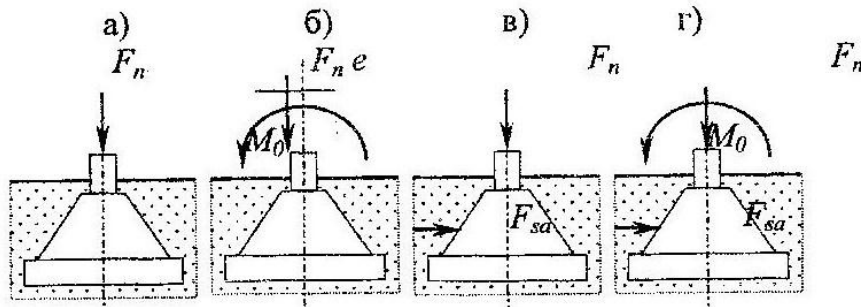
Схемы приложения нагрузок на фундамент: а) на фундамент действует сосредоточенная сила F_n (например, вес колонны, нагрузка от конструкции перекрытия, фермы и т.п.), б) на фундамент передается сосредоточенная сила F_n с эксцентриситетом e , создающая момент M_0 , (например, колонна с консолью, на которую опирается кран); в) на фундамент передается сосредоточенная F_n и горизонтальная F_{sa} силы (например, вес колонны, давление грунта на обрезах); г) на фундамент передается три составляющих: сосредоточенная F_n и горизонтальная F_{sa} силы, момент M_0 (например реакция подпорной стенки)
